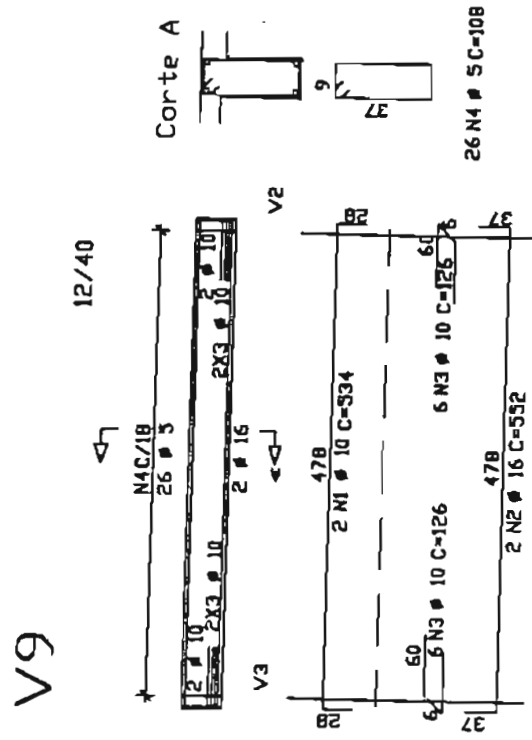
Detalhe de armadura da viga V9 (viga contínua)
